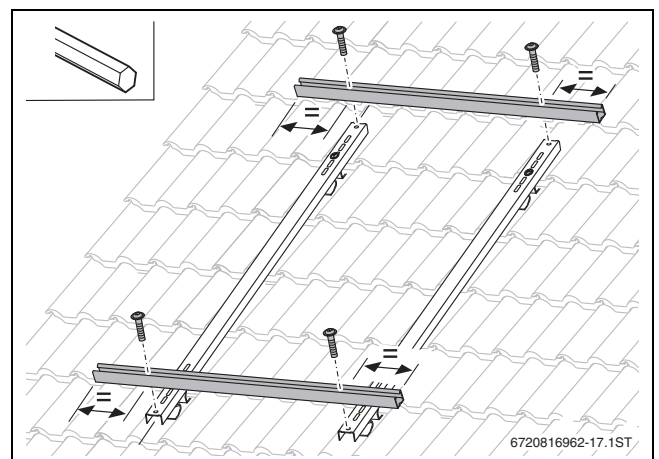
Profilschienen mit Schraube und Nietmutter verbinden
